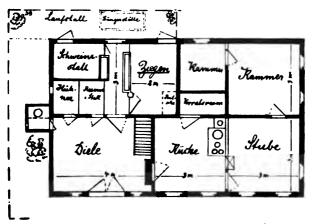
Grundriß eines Haufes mit Stallanlage für Rleinvieb., insbesondere Liegenhaltung; Maßstab 1:100.
